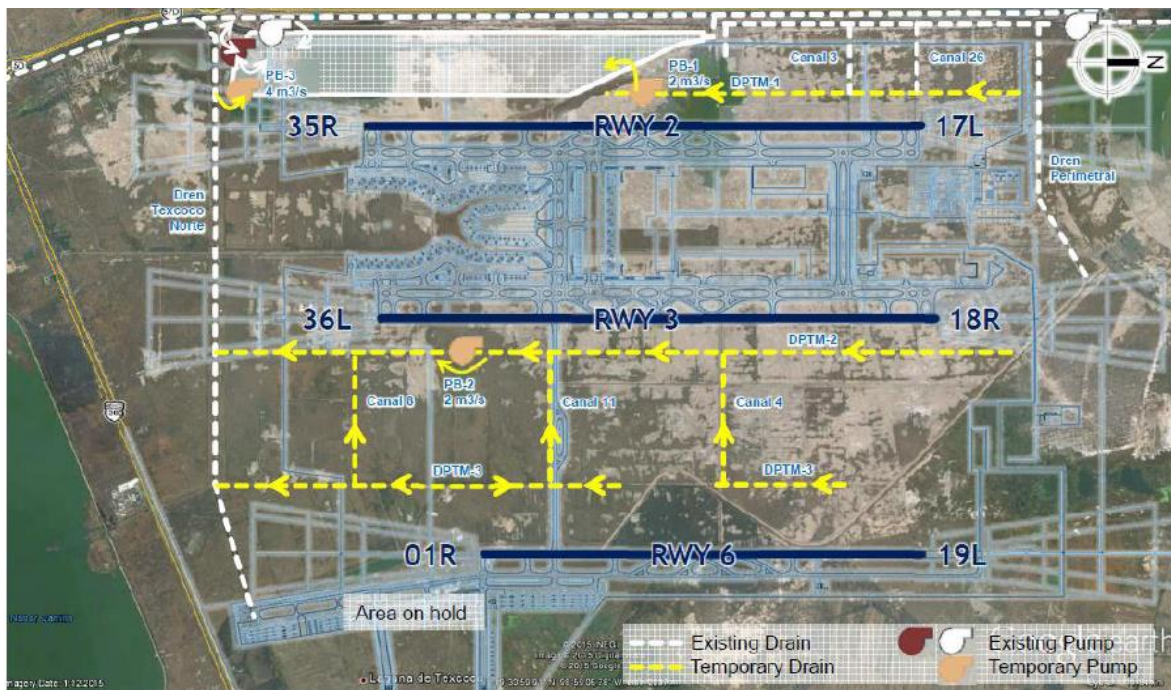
Figura en planta del Drenaje Pluvial Temporal Modificado (DPTM)
